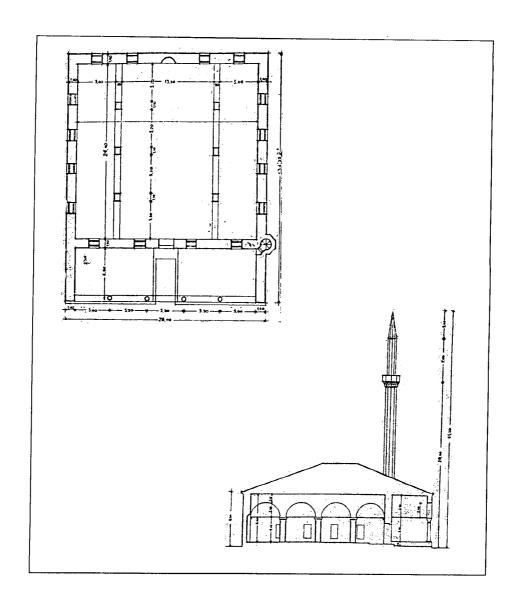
مسقط أفقي لمسجد ذنجرلي في سيريز باليونان (عن : كيل)
